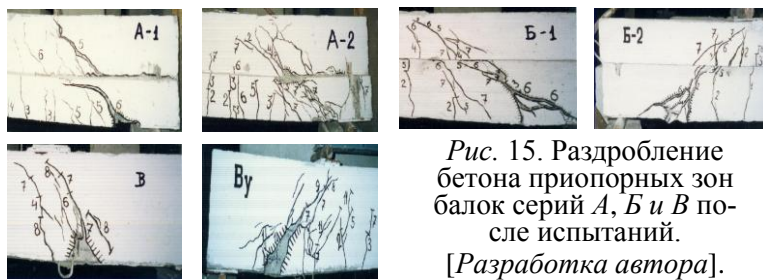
Раздробление бетона приопорных зон балок серий А, Б и В после испытаний.
